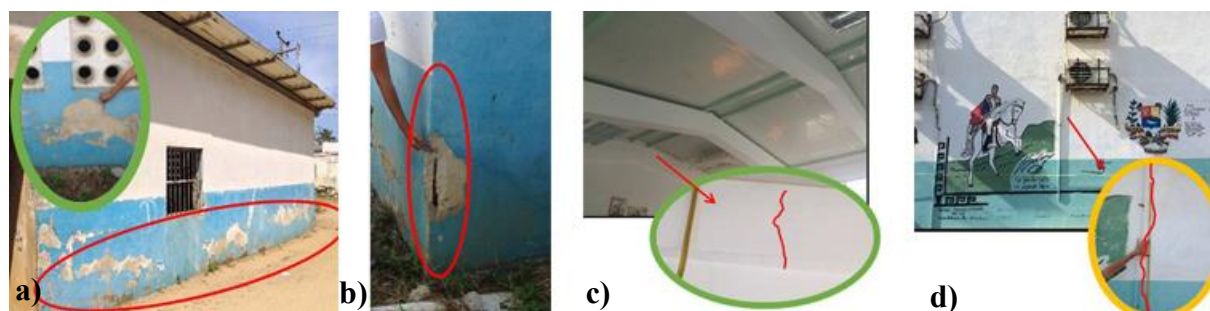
Fallas observadas: a) Humedades y desprendimientos de friso en fachadas, b) Desprendimiento del recubrimiento y delaminación del acero en columna, c) Grieta transversal en viga, d) Grieta transversal en el centro del cerramiento
